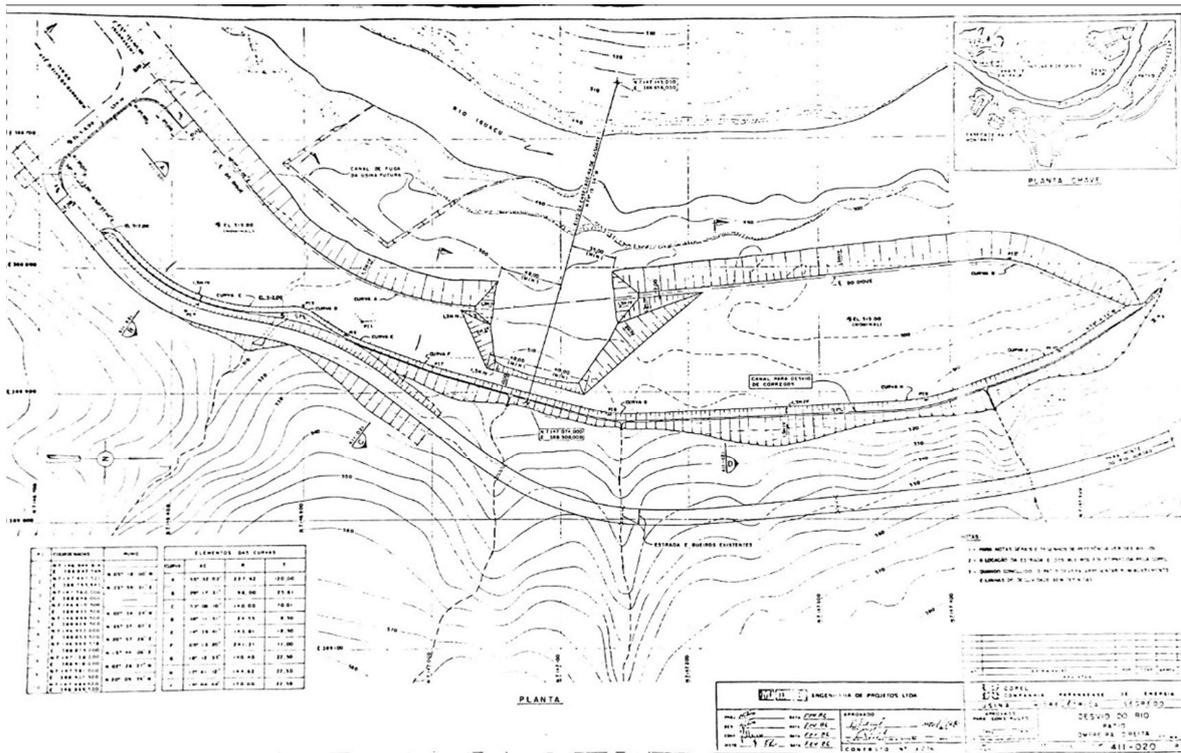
Planta indicando a localização da canaleta de drenagem construída na época da obra.
